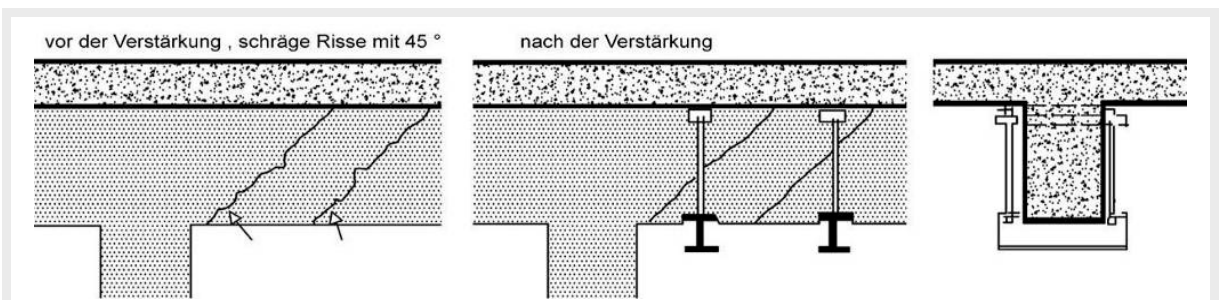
Verstärkung lokal gerissener Stahlbetonträger (bearb. n. BERKAWI, 1984)
